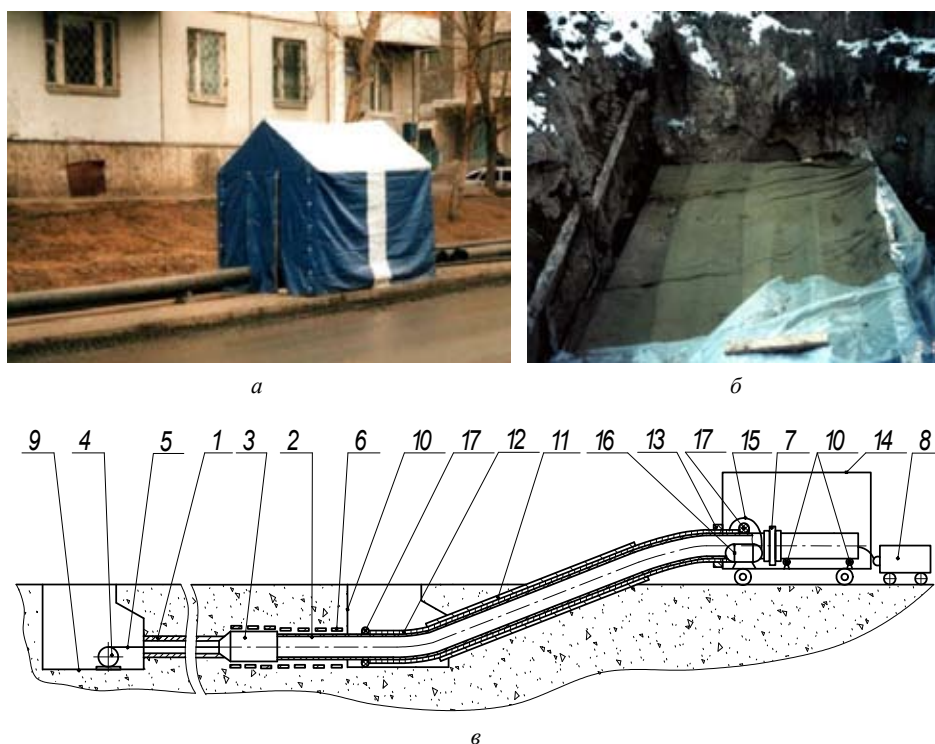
Сварка нового пластмассового трубопровода в палатке (а), в обогреваемой приемке (б) и в тепляке (в): 1, 2 – старый и новый трубопроводы; 3 – рабочий механизм; 4 – тяговый орган; 5 – тяговый элемент; 6 – обломки старого трубопровода; 7 – устройство для стыковой сварки пластмассовых труб; 8 – компрессор; 9, 10 – приемки или колодцы; 11 – обсадная труба; 12 – теплоизолирующий рукав; 13 – фланец; 14 – тепляк; 15 – гибкий патрубок; 16 – теплогенератор; 17 – прижимное кольцо
